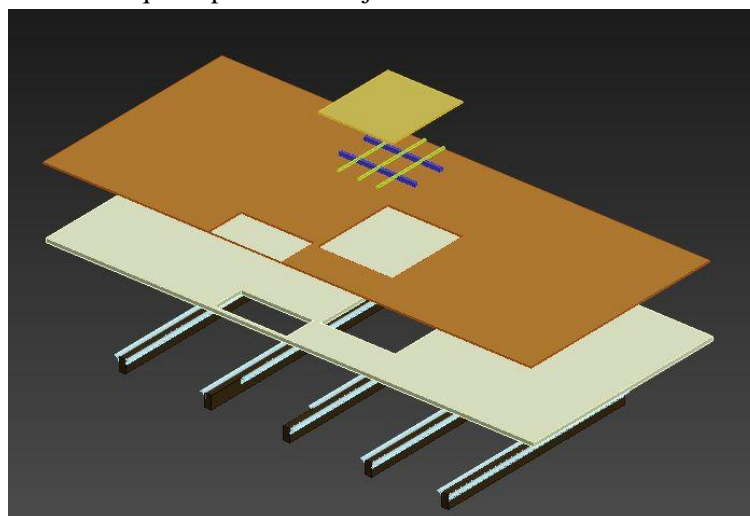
Descomposición esquemática de los elementos que conforman el techo de la planta baja / suelo de la planta primera.
